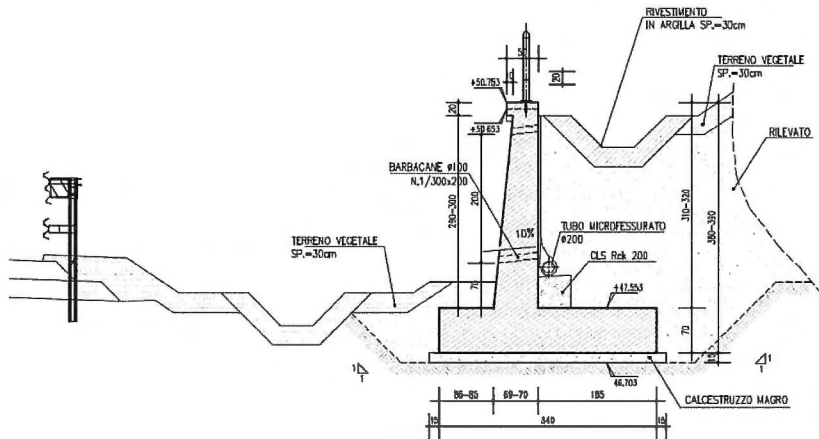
Sezione Tipo - Muro 3 Concio 4
